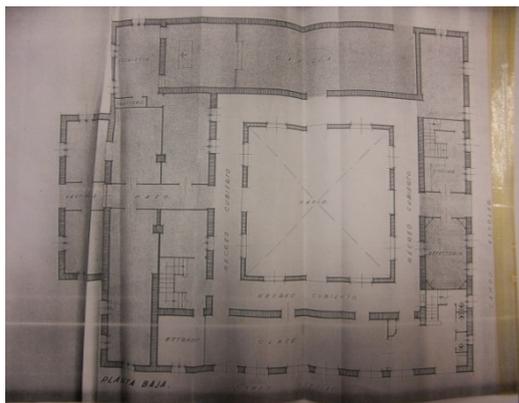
Imagen del plano original de planta baja del Convento de las Capuchinas. 1.950. Archivo Municipal
